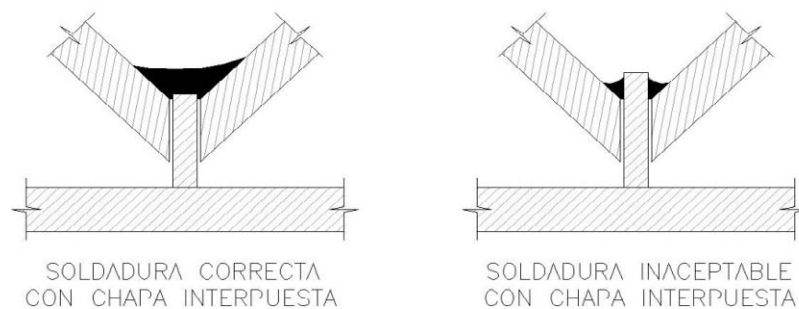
Ejemplos de soldadura aceptable e inaceptable en el caso de chapa interpuesta
